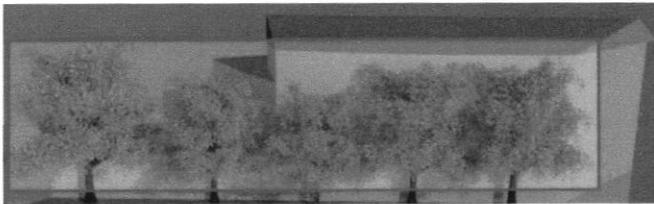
esquisse de la façade ouest du projet / source : auteur
